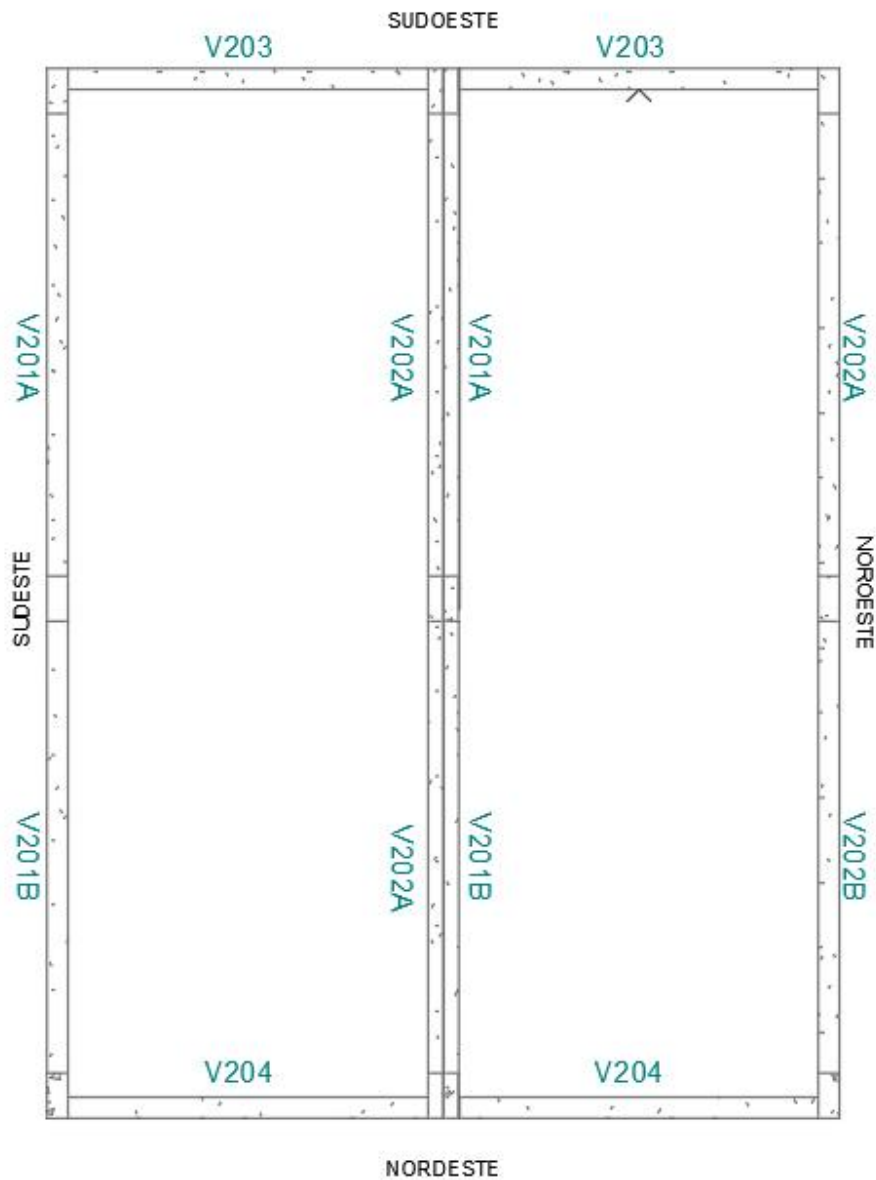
Planta Baixa com Nomeação das Vigas - Nível 200 (Cobertura).
